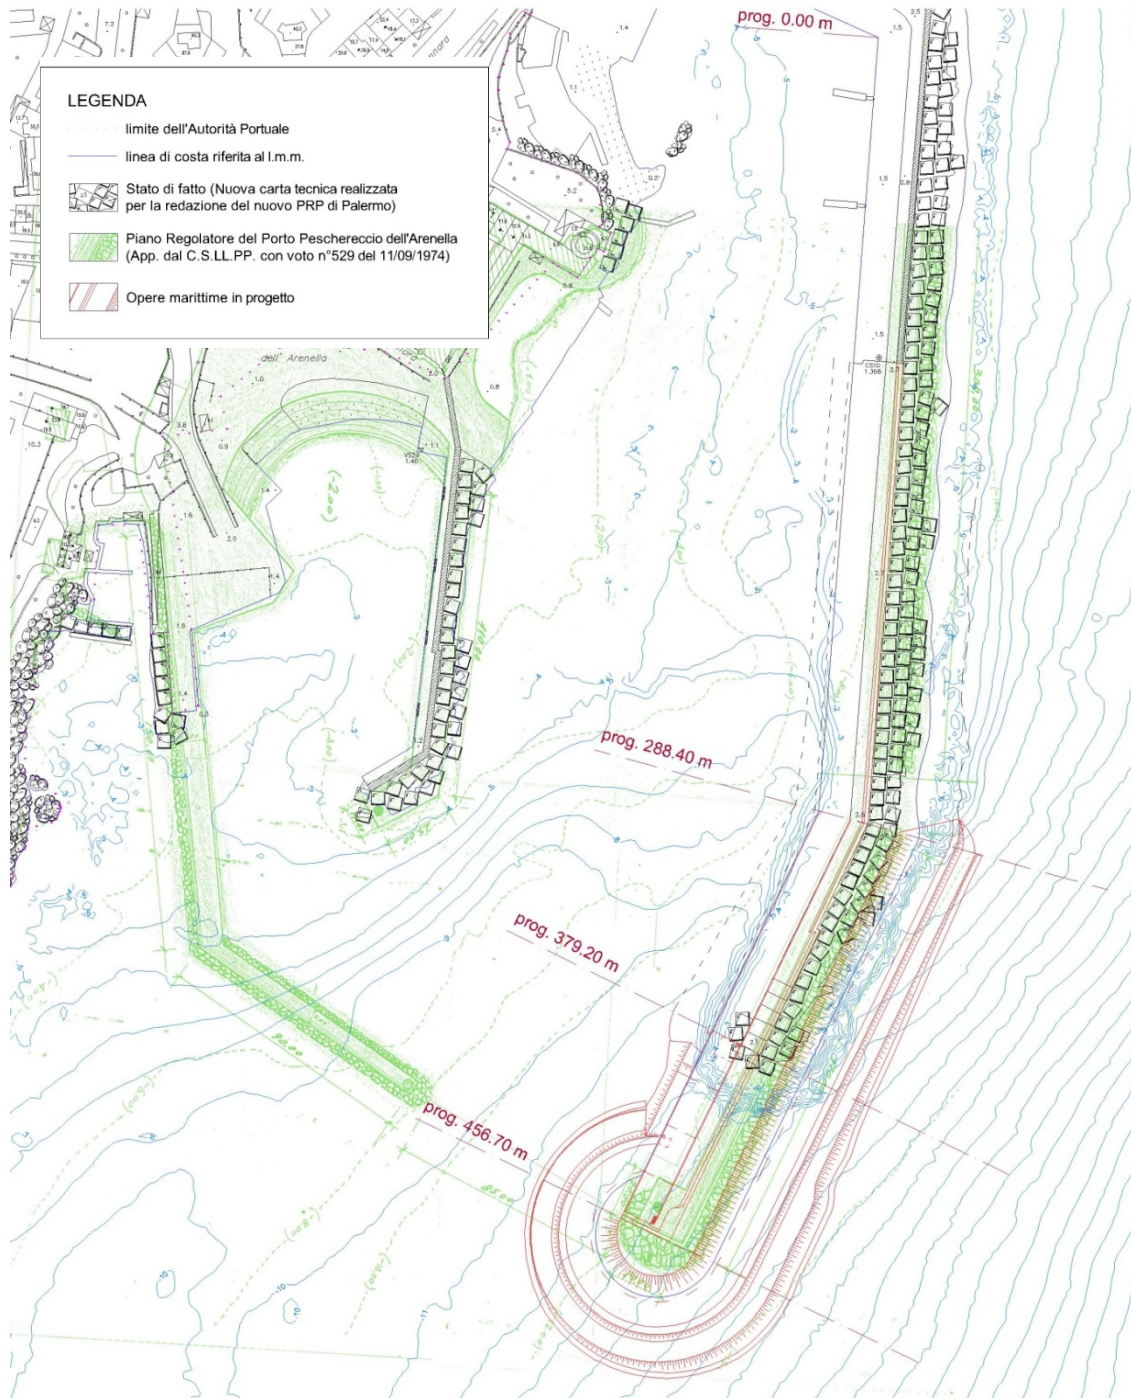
planimetria relativa al raffronto Opere in Progetto – Stato di Fatto, con le indicazioni relative alle specifiche del piano regolatore portuale vigente.
